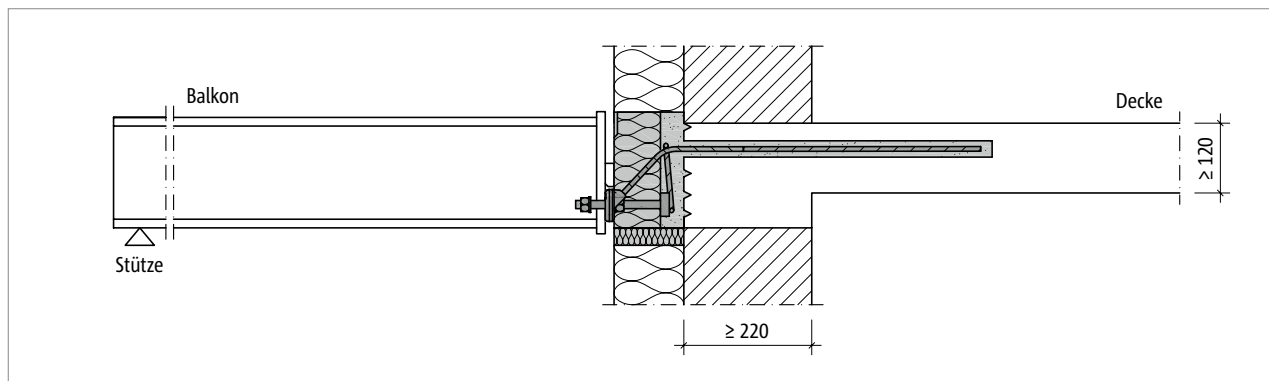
Schöck Isokorb® RT Typ SQ: Anschluss bei Wärmedämmverbundsystem (WDVS) und dünner Decke
